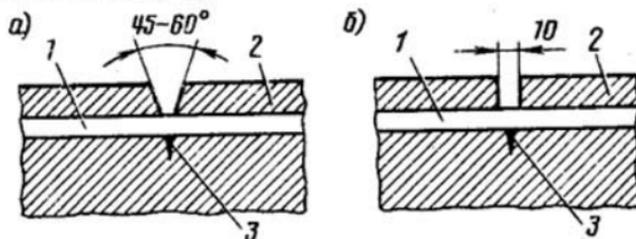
Схемы разделки трещин: 1 – арматурный стержень; 2 – защитный слой бетона; 3 – трещина
